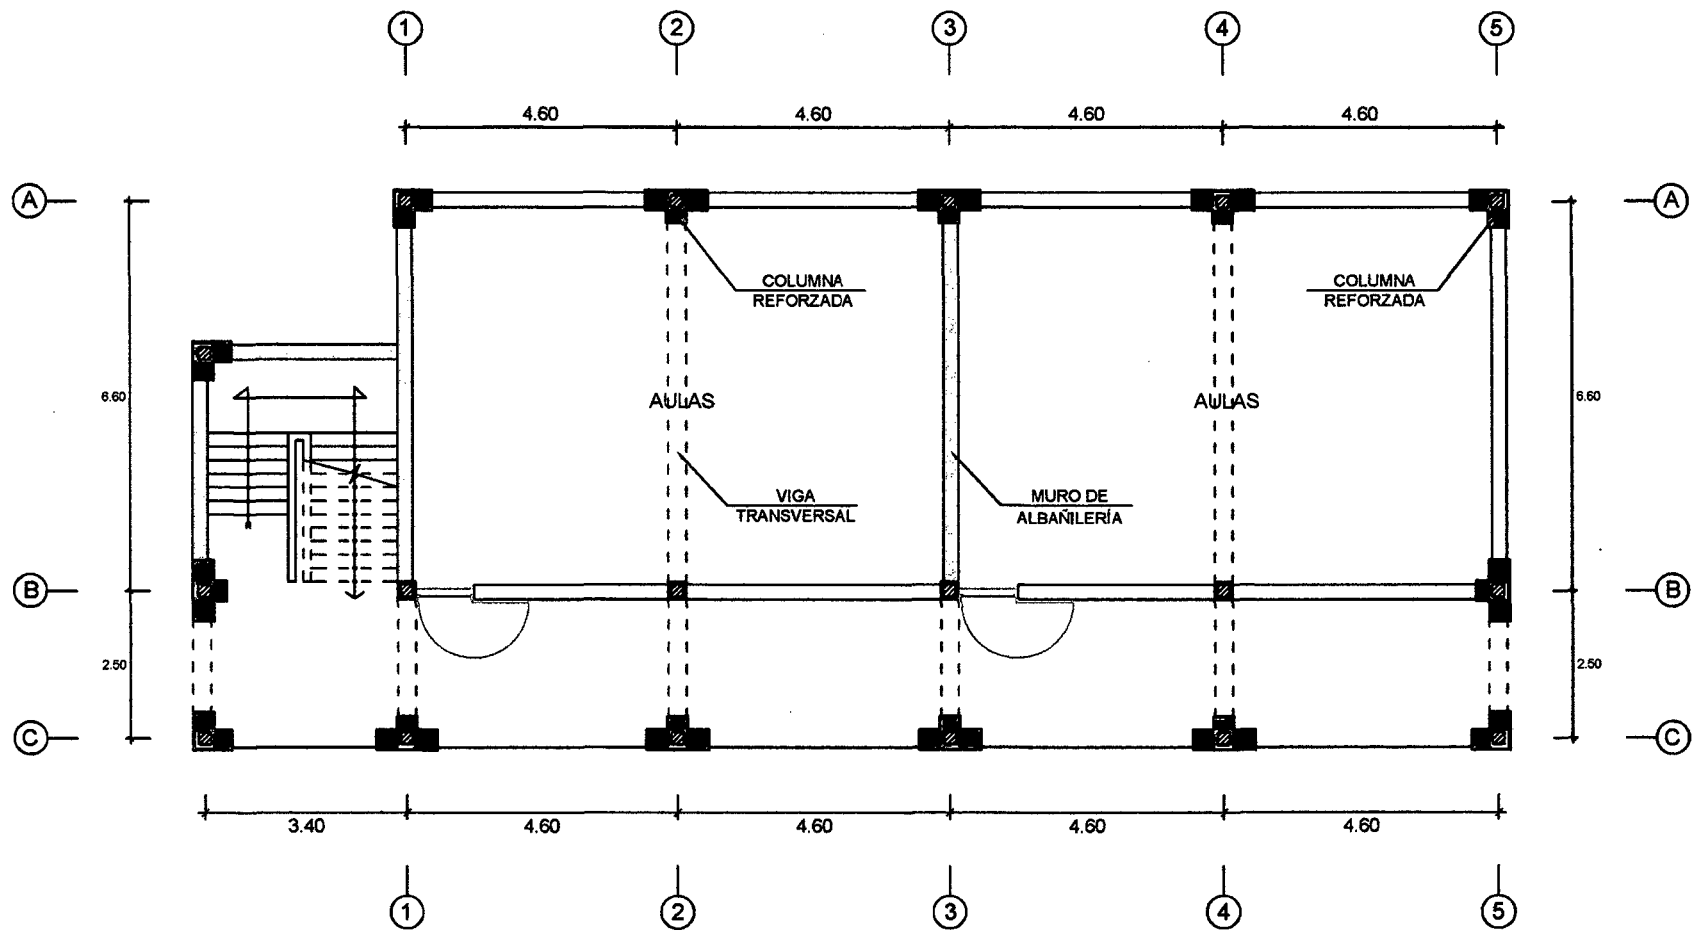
Reforzamiento del pabellón 1 incorporando columnas T y L.
